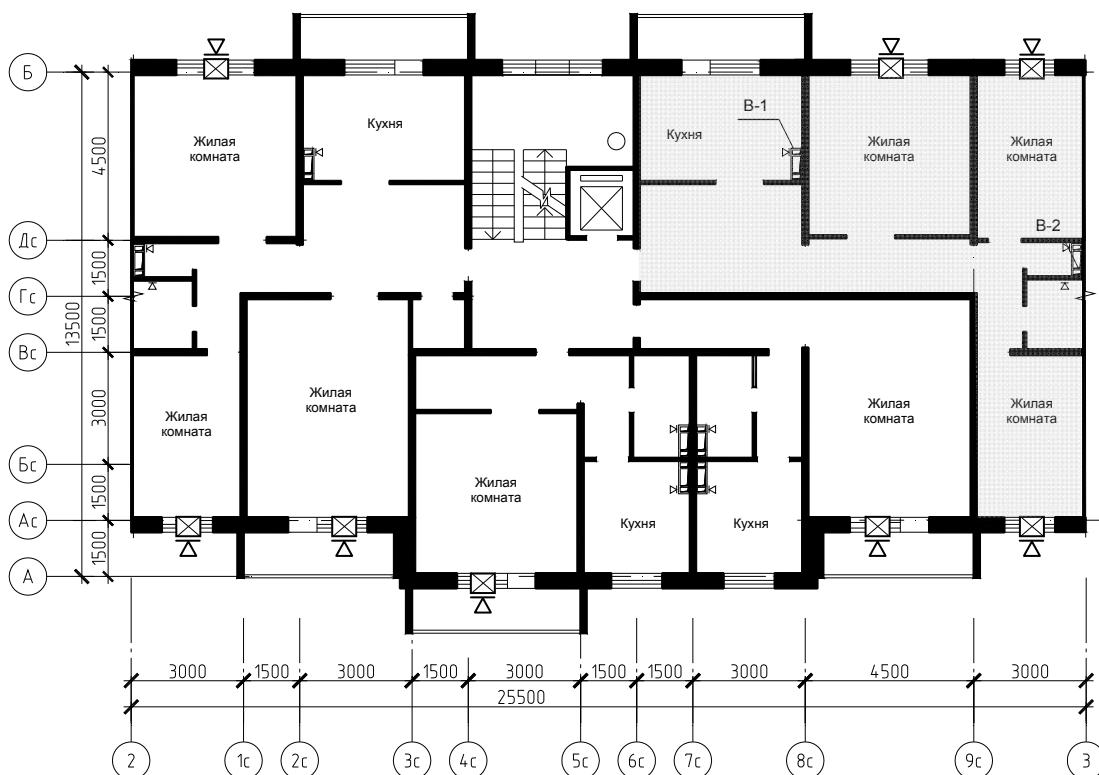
Схематичный план рядовой секции многоэтажного жилого дома
